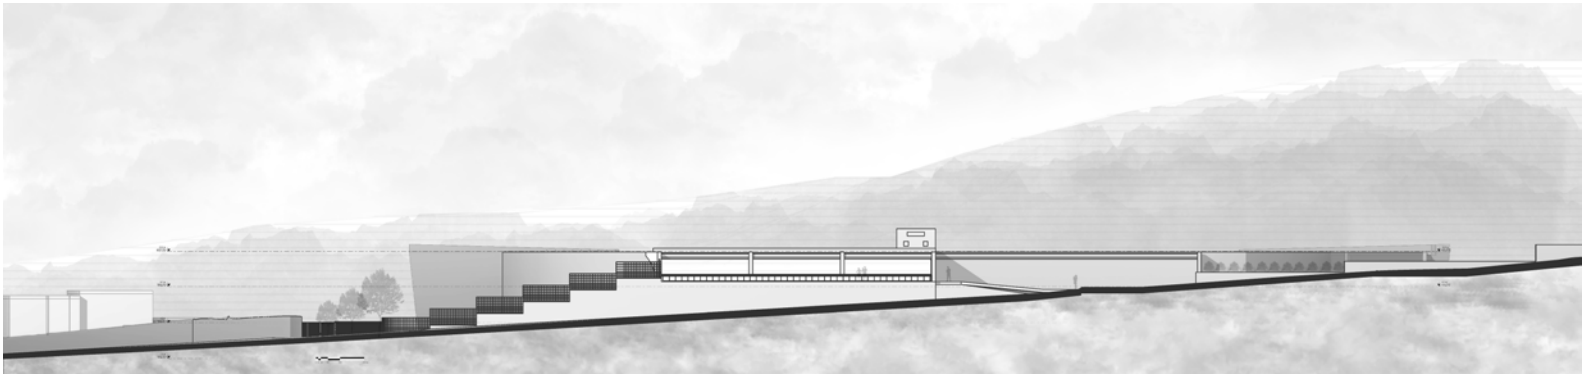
Elevación posterior. Elaboración: Autores.
